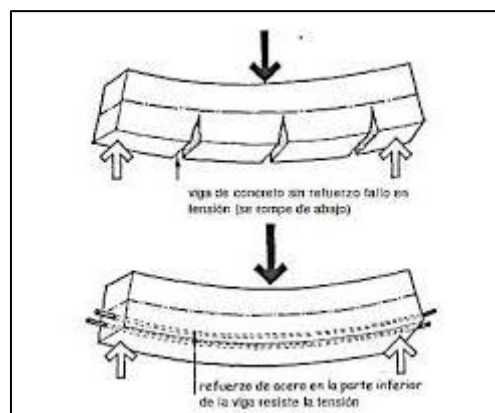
Ejemplo de viga sin refuerzo y viga con acero pretensado
